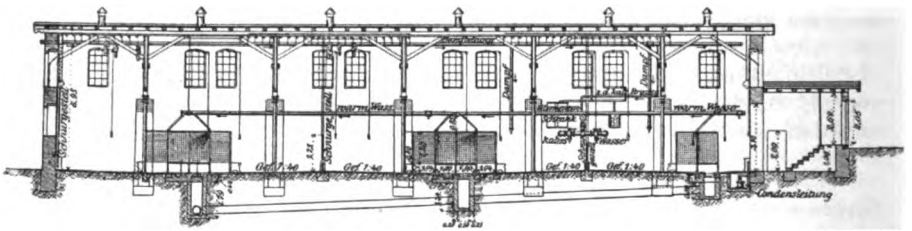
Brausebad auf Grube Dudweiler. Längsschnitt.
